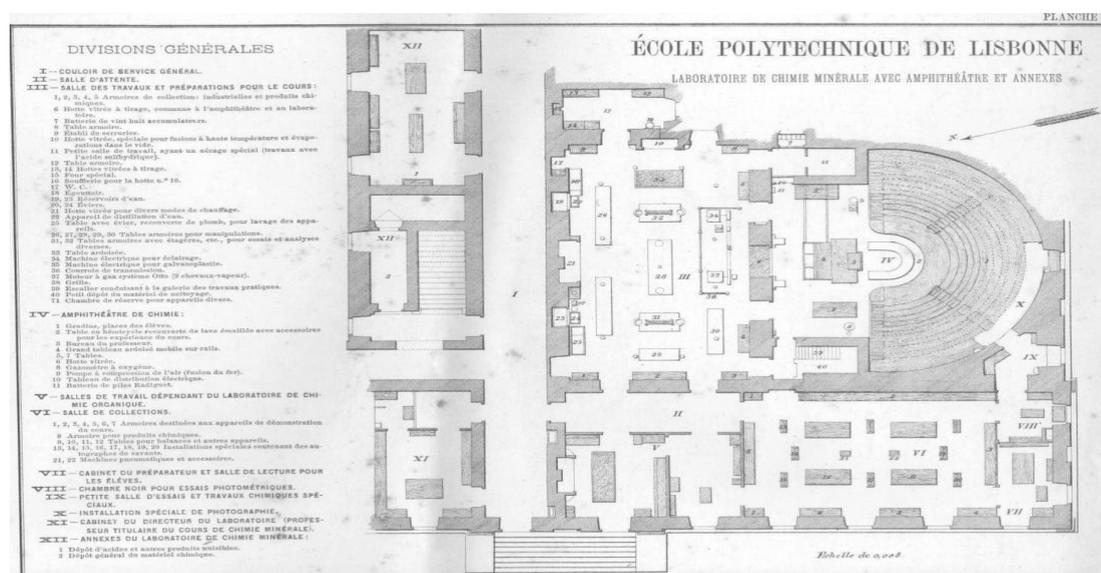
Planta do *Laboratorio Chimico* e Anfiteatro depois do plano de reestruturação, Litografia da Imprensa Nacional (AHMUL-MUHNAC)
